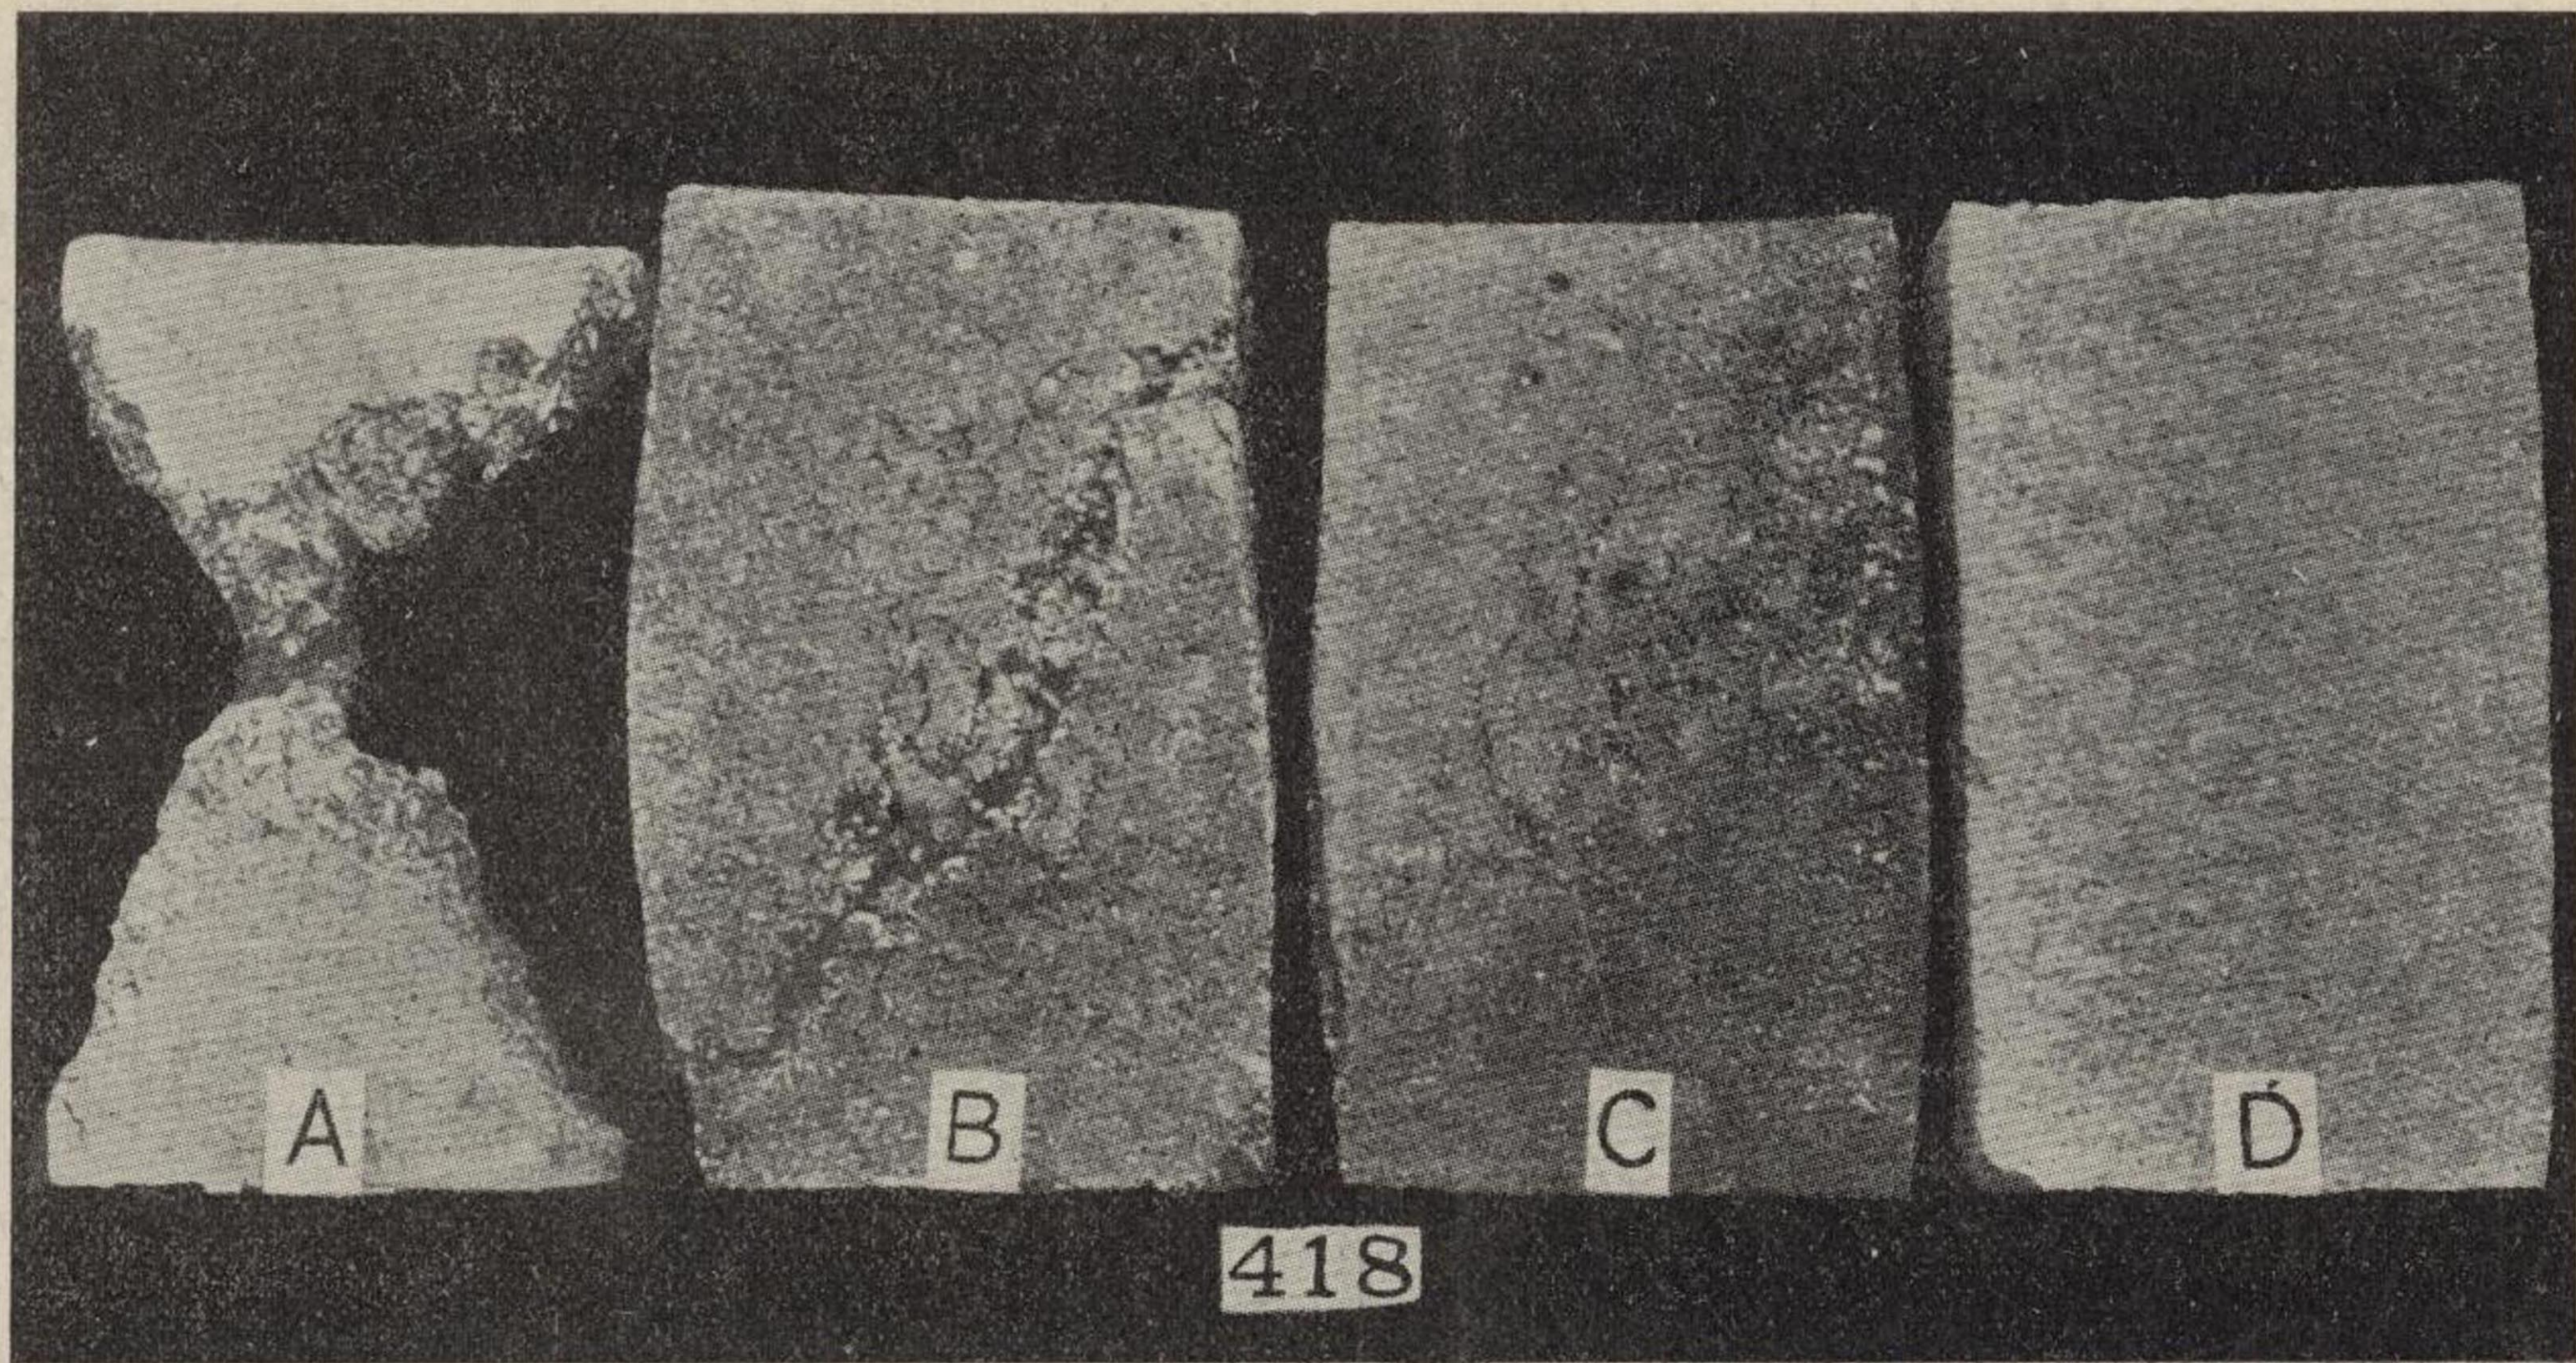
Los ladrillos después del ensayo de aplastamiento bajo cargas. (Ensayo americano.)
